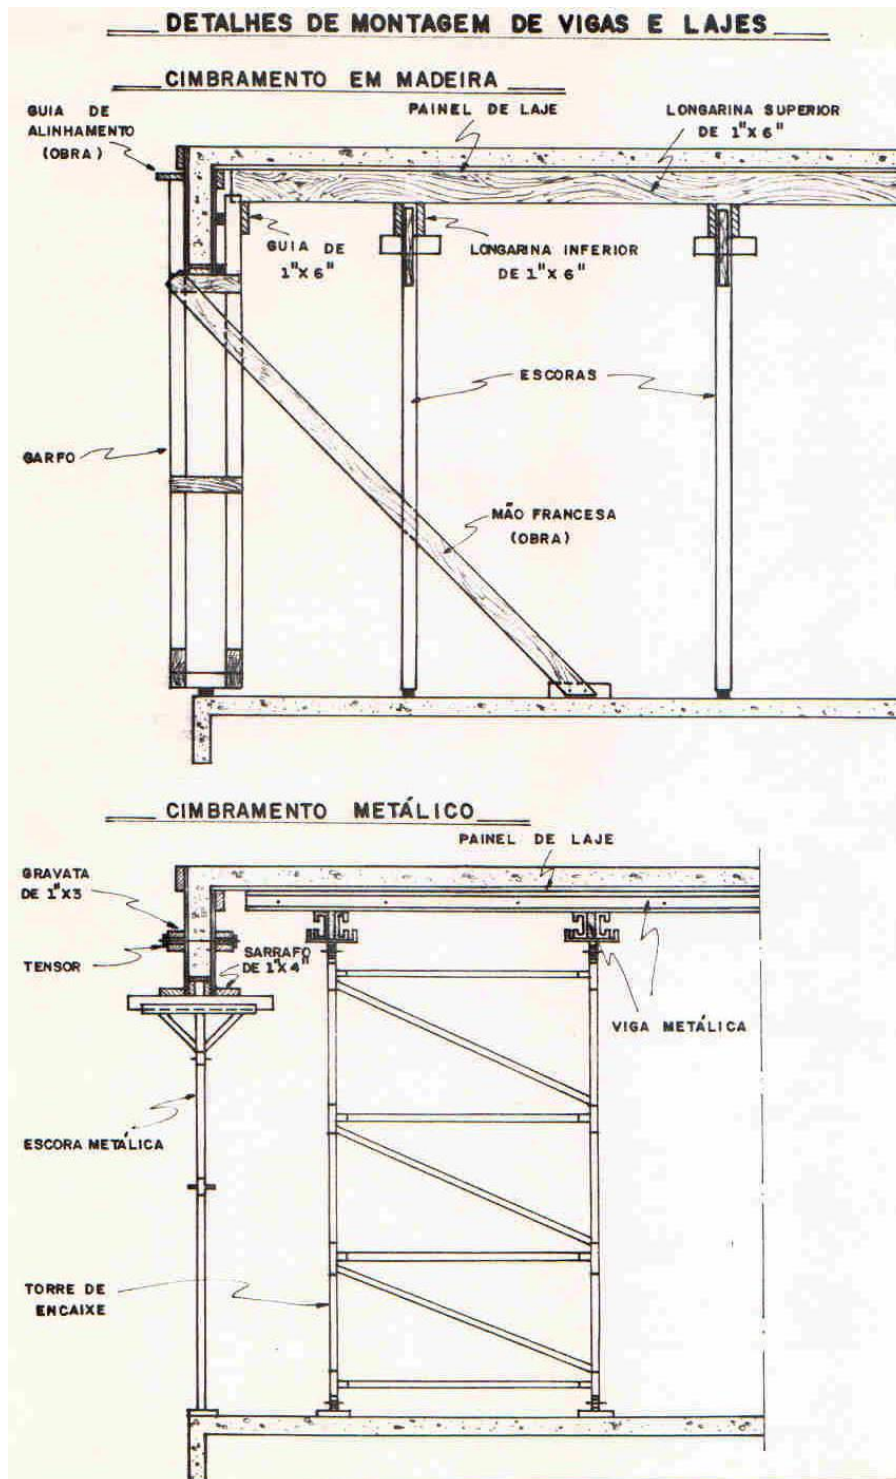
Disposição de formas e cimbramentos para vigas e lajes. Fonte: CHADE (1986).
